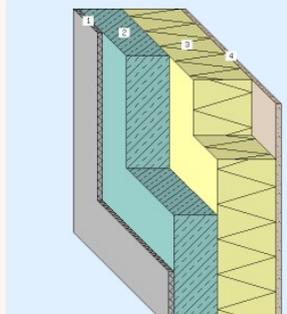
Stahlbetonwand mit EPS Wärmedämmung [33]
